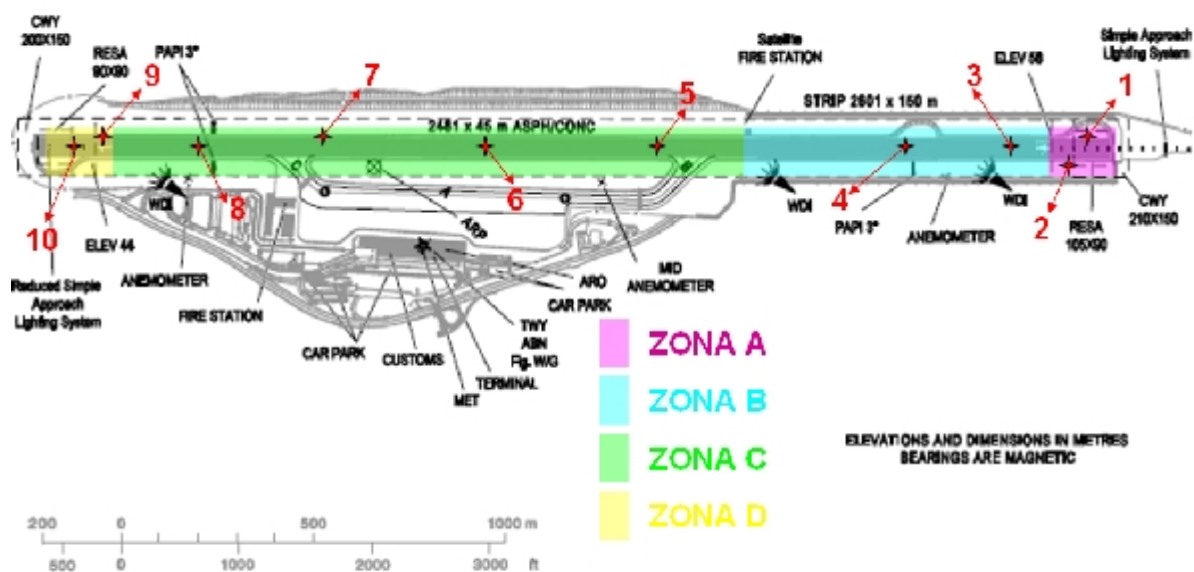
Subdivisão em zonas da Pista 05/23 do Aeroporto da Madeira
